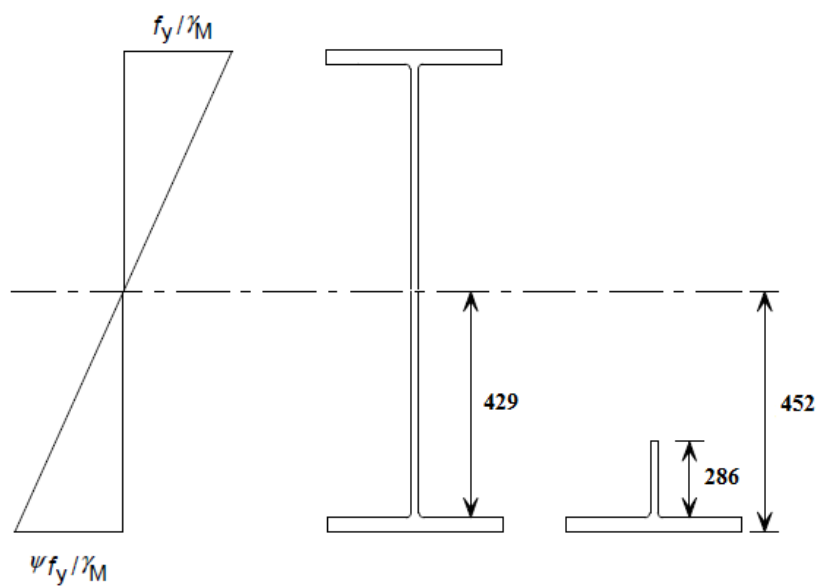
Perfil equivalente com secção em T (secção 3)
